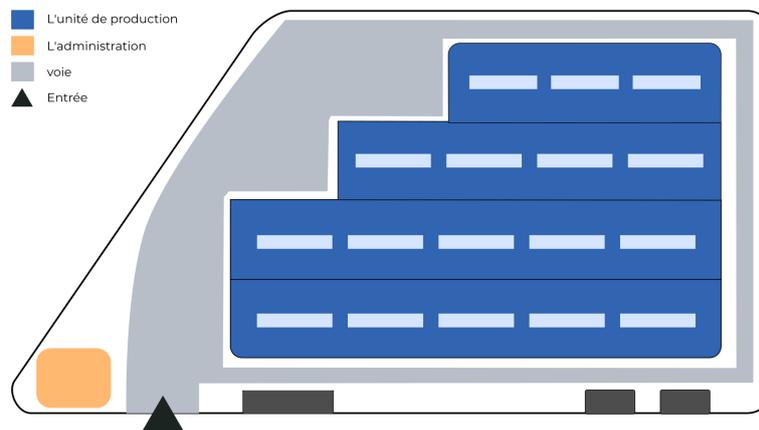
Plan de masse de l'usine d'Oran
